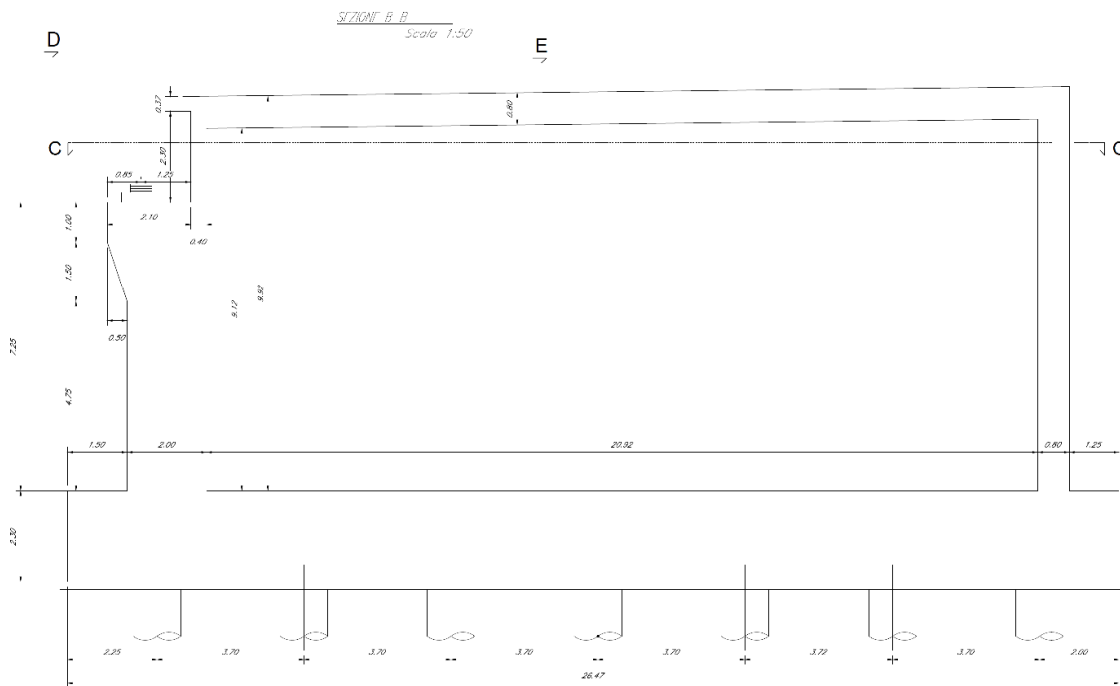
Sezione longitudinale Spalla B (asse tracciato)
